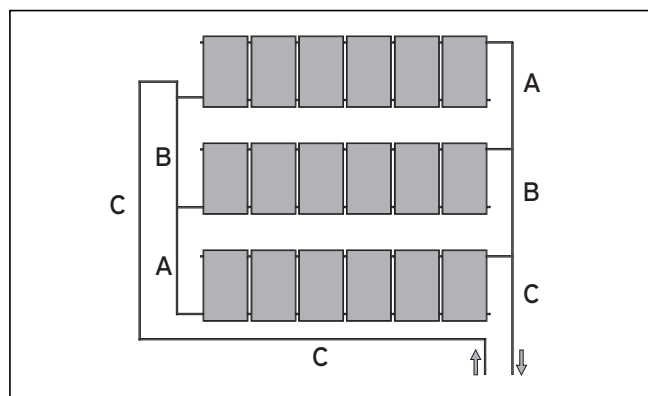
Dimensionado de las tuberías en los segmentos de tuberías
